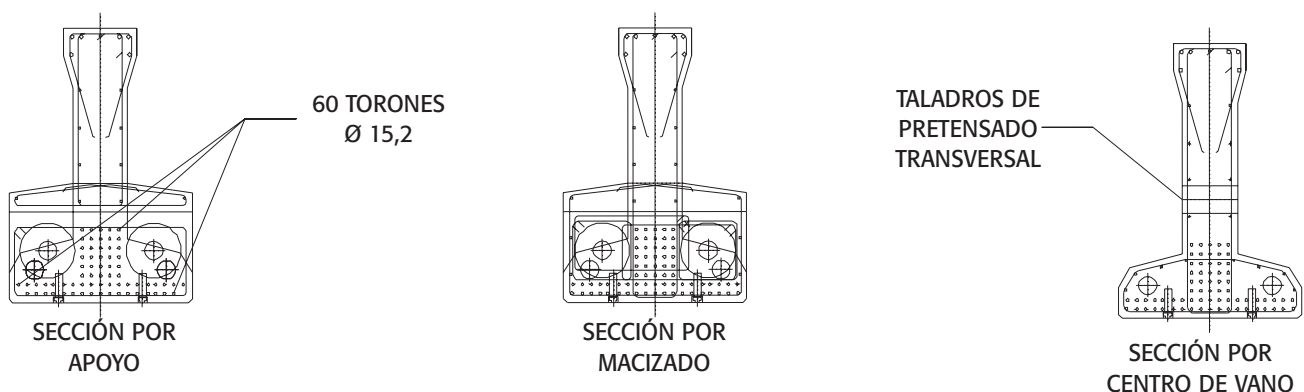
Armadura de las vigas, en viga aislada de sección (S1)
